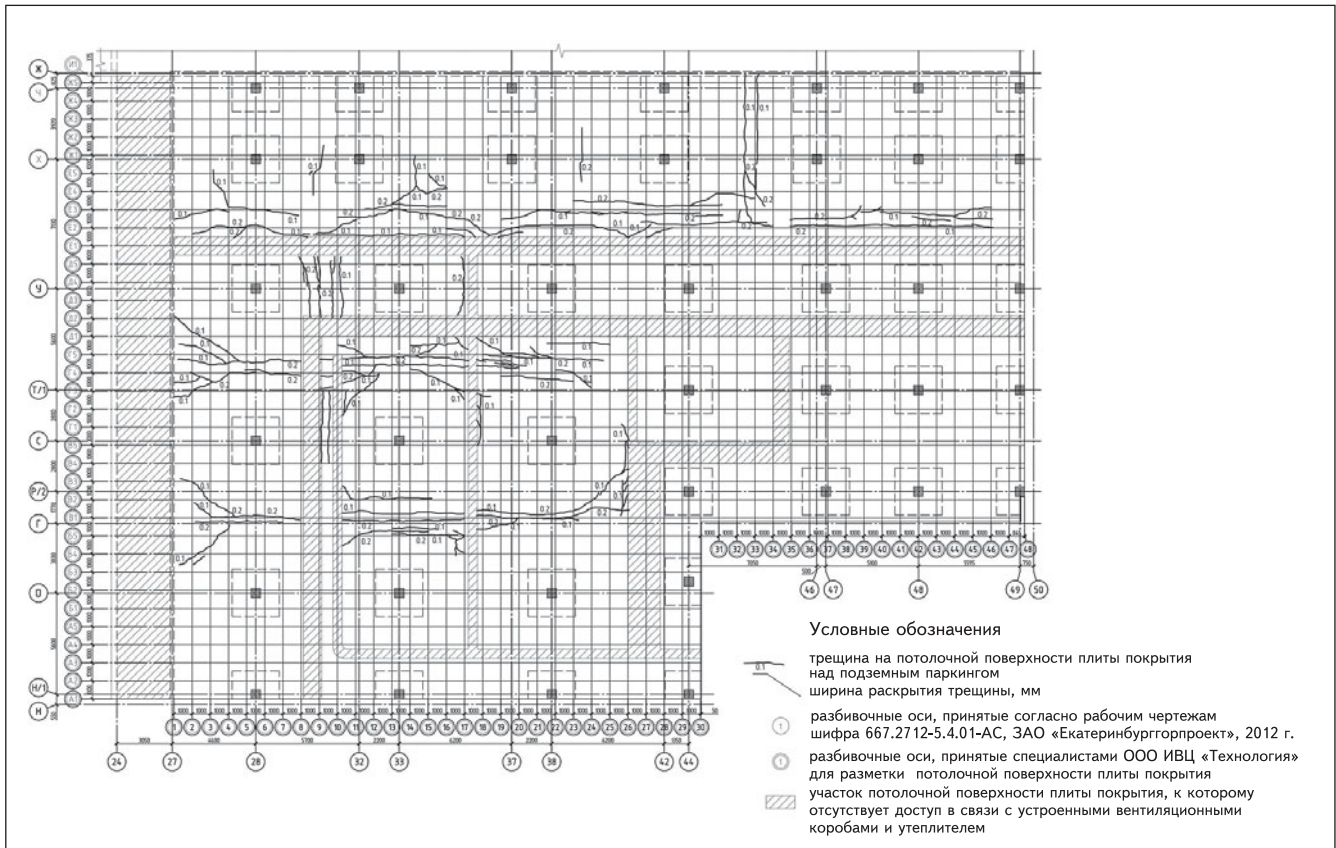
Схема расположения и ширина раскрытия трещин на поверхности железобетонной плиты покрытия подземного паркинга
